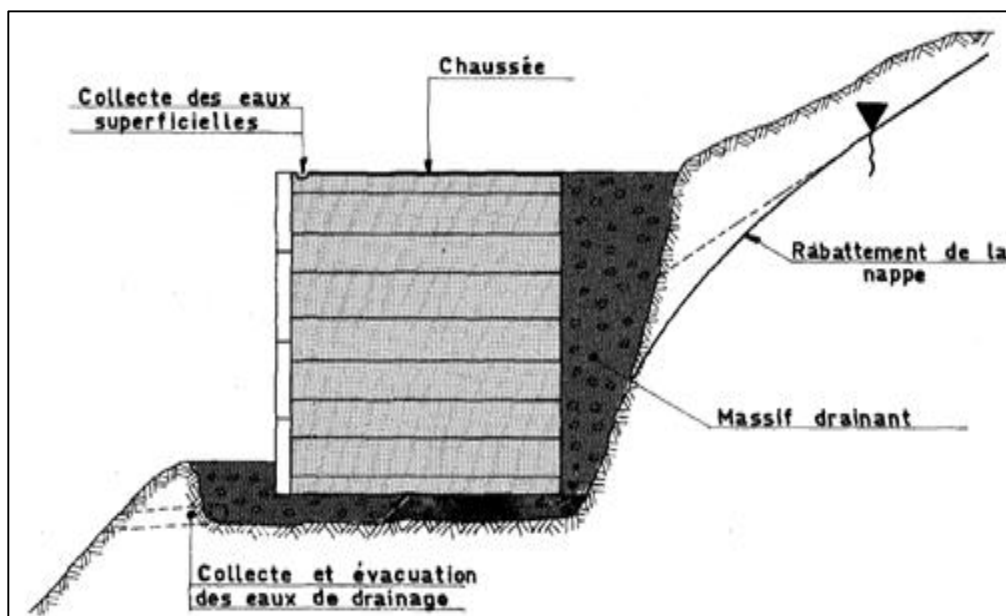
Dispositif de drainage autour d'un mur en terre armée (Ouvrages en TA
